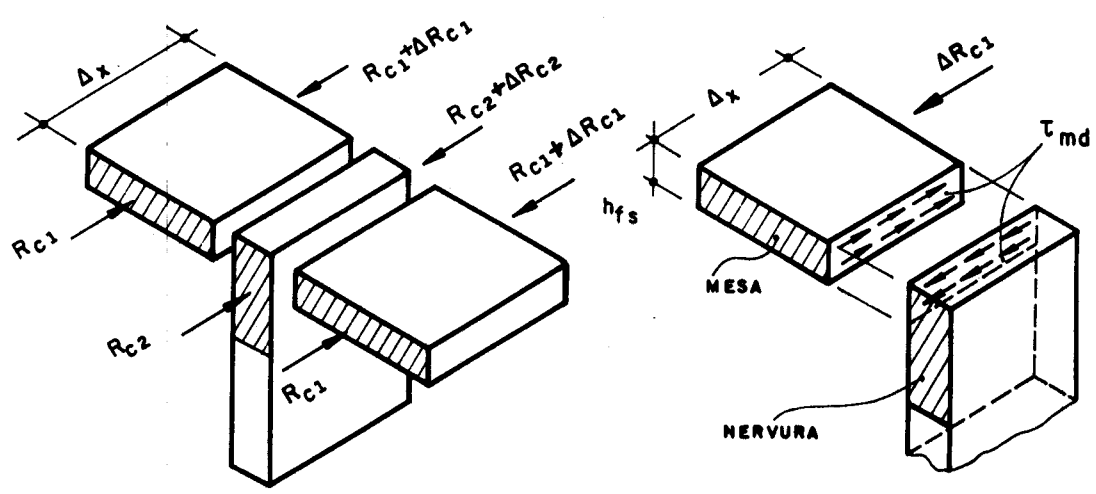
TENSÕES NA LIGAÇÃO ALMA-MESA - ANDRADE⁴⁸
